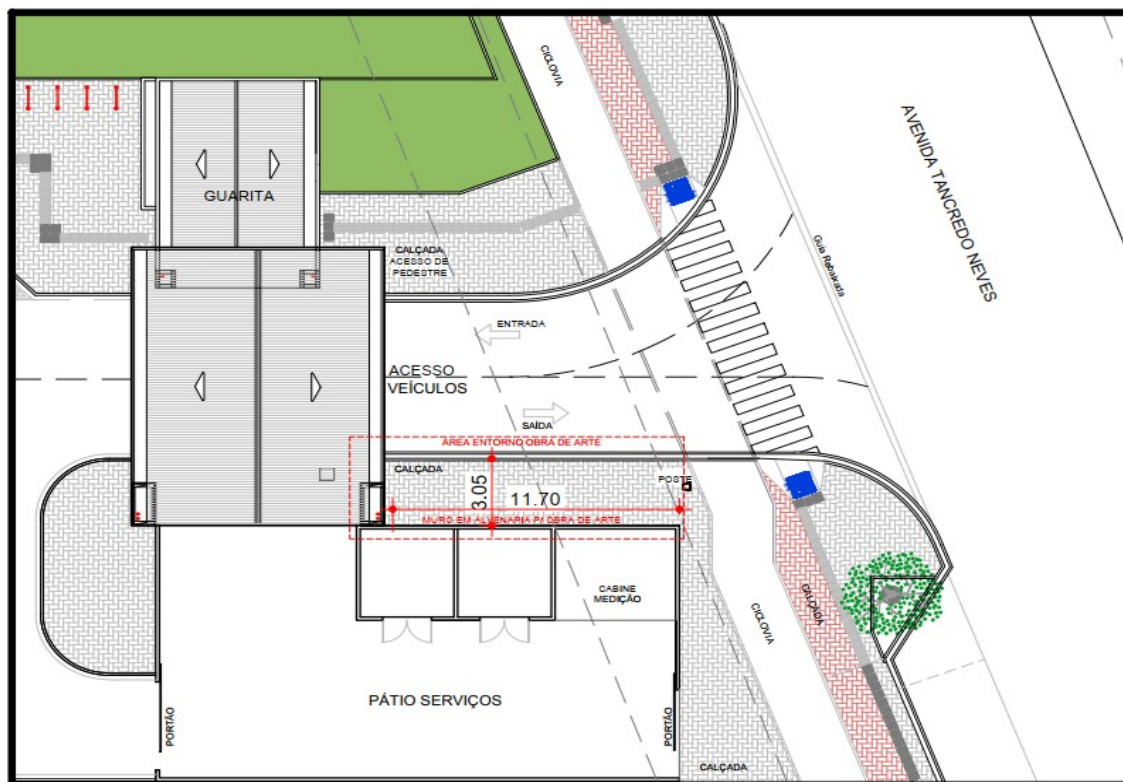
Planta Baixa do acesso ao Alojamento – Indicação do local da obra de arte
